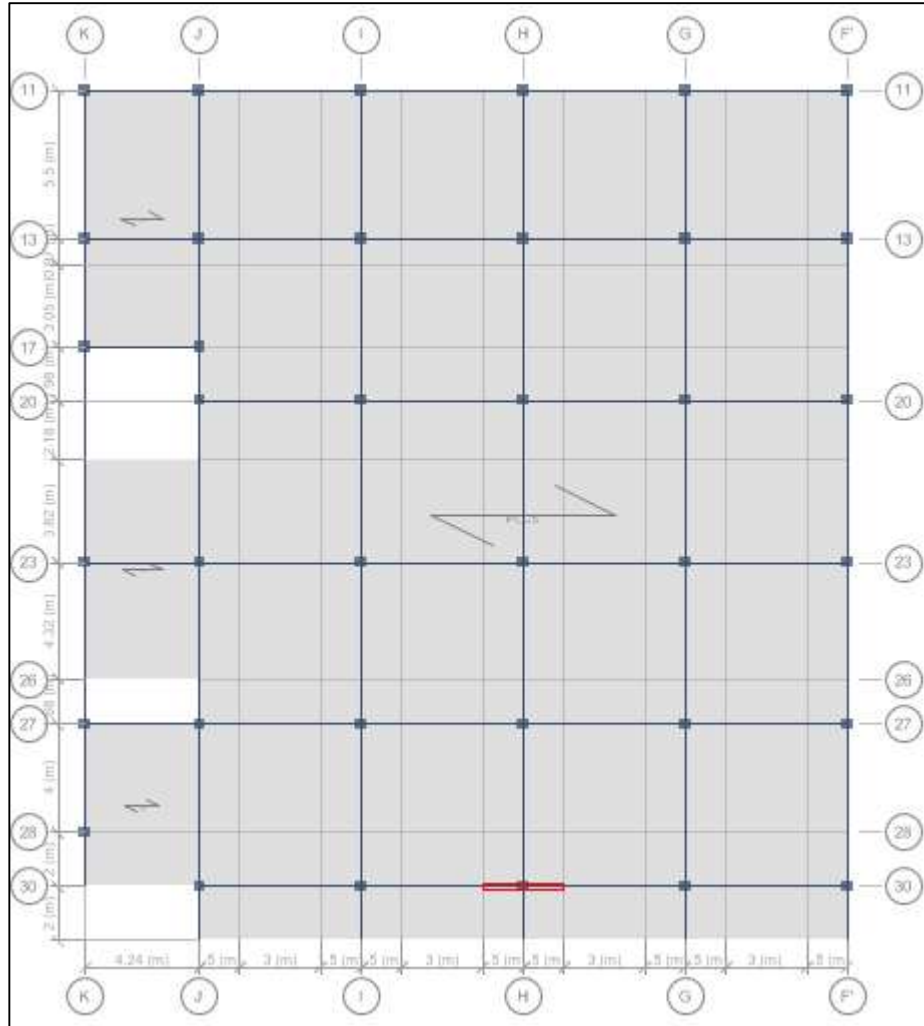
Esquema de ubicación de muro en concreto, Estructura 5.32 Hotel
